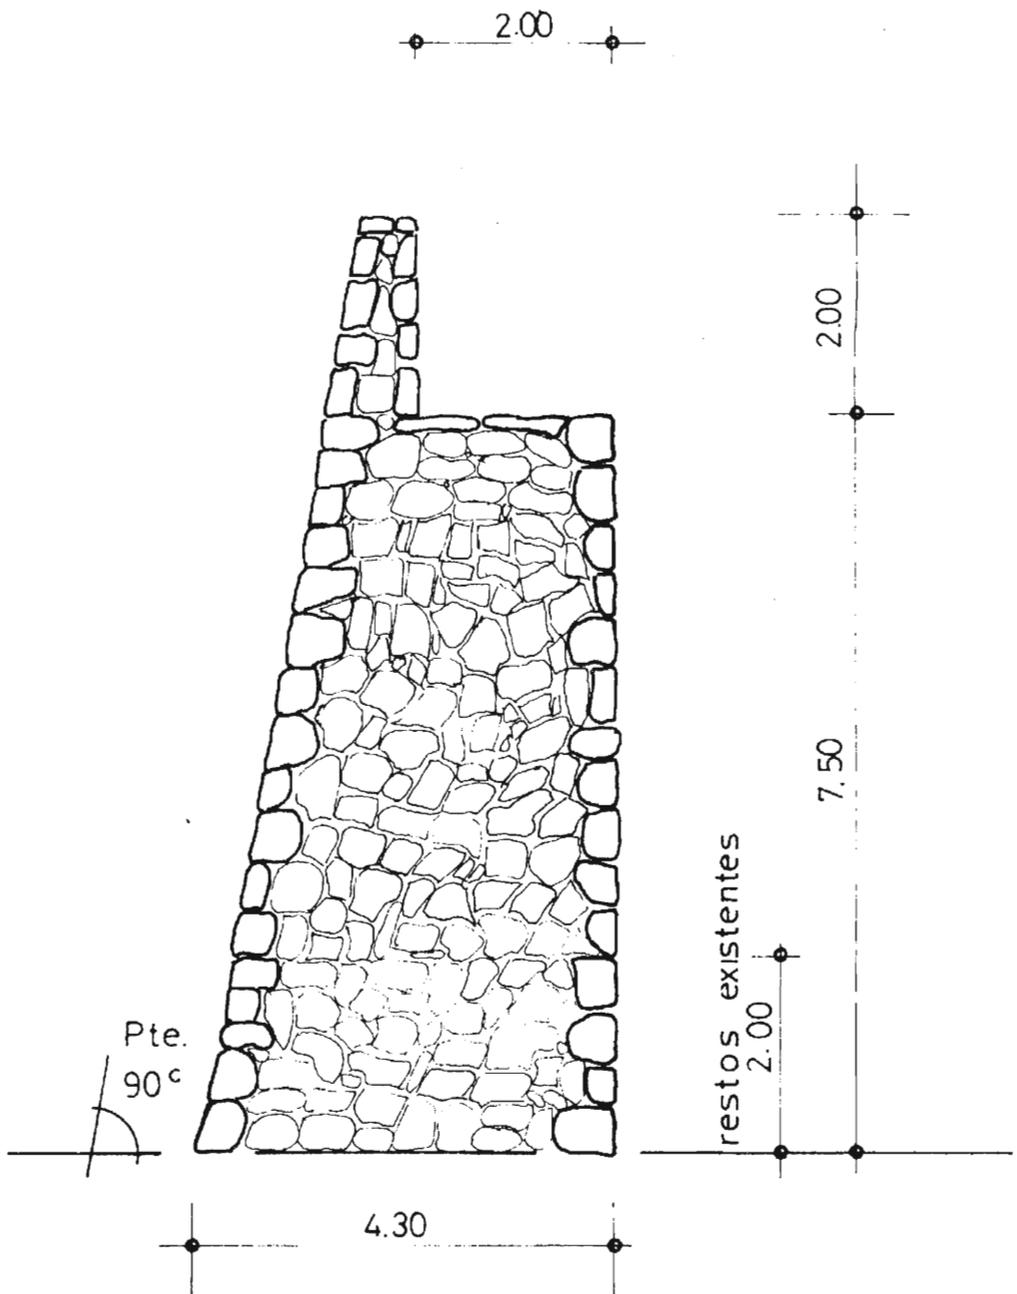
Sección de la reconstrucción hipotética de la muralla.
